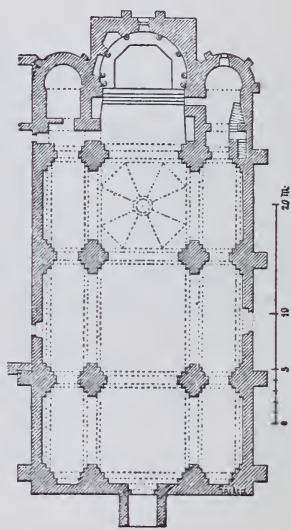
Grundriss der Abteikirche zu Vaison.
